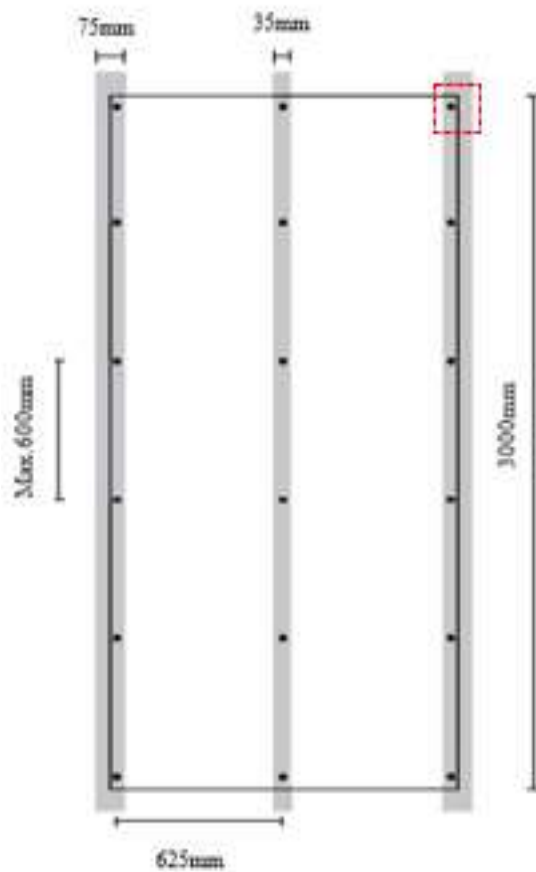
Fixação do painel na aplicação em paredes e revestimento de paredes.
